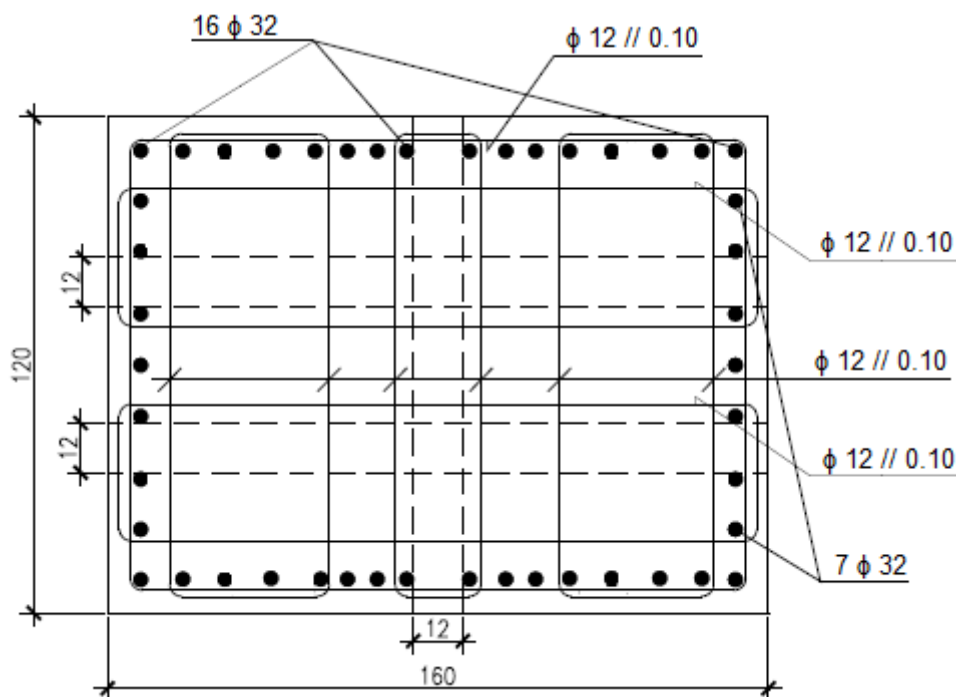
Solução final de armaduras para as secções basais dos pilares
